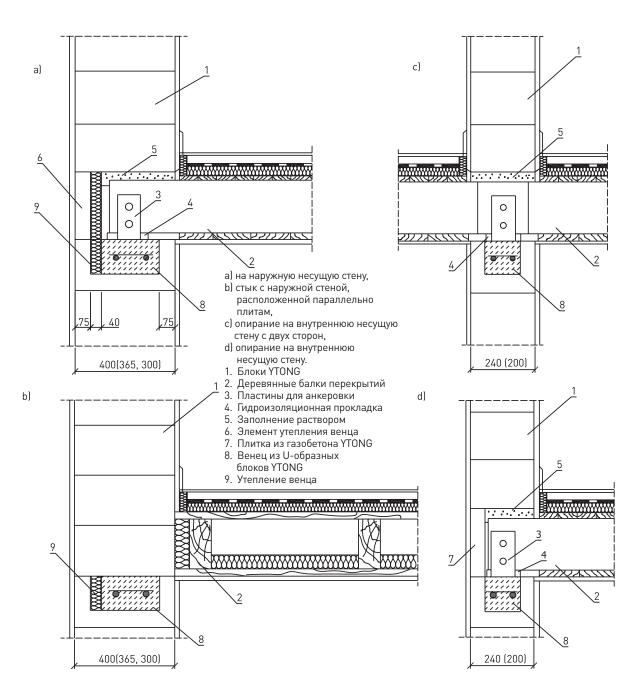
Опирание деревянных балок перекрытий
